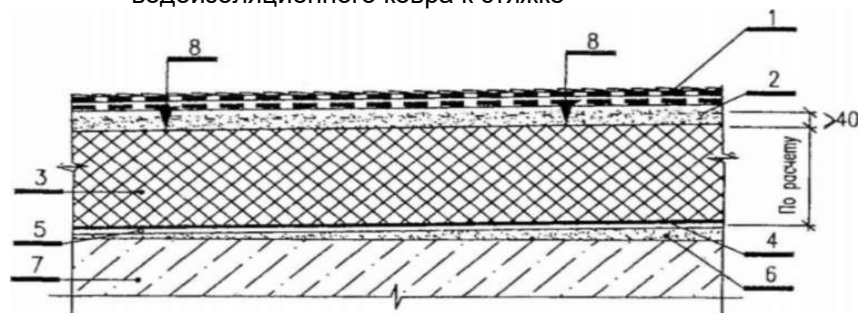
Кровля с утеплителем из горючих материалов и механическим закреплением первого слоя водоизоляционного ковра к стяжке
